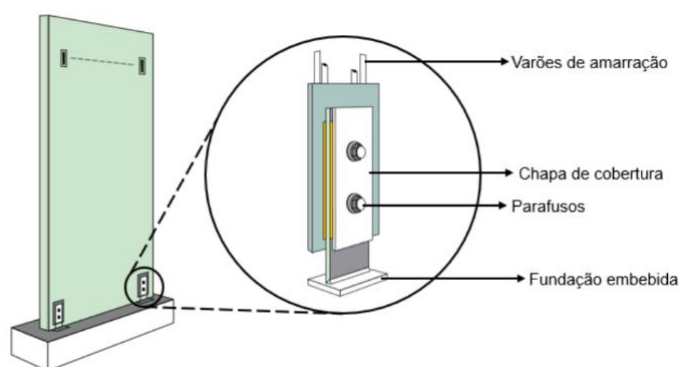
Exemplo ilustrativo de ligações secas entre parede e fundação, adaptado de [1].
